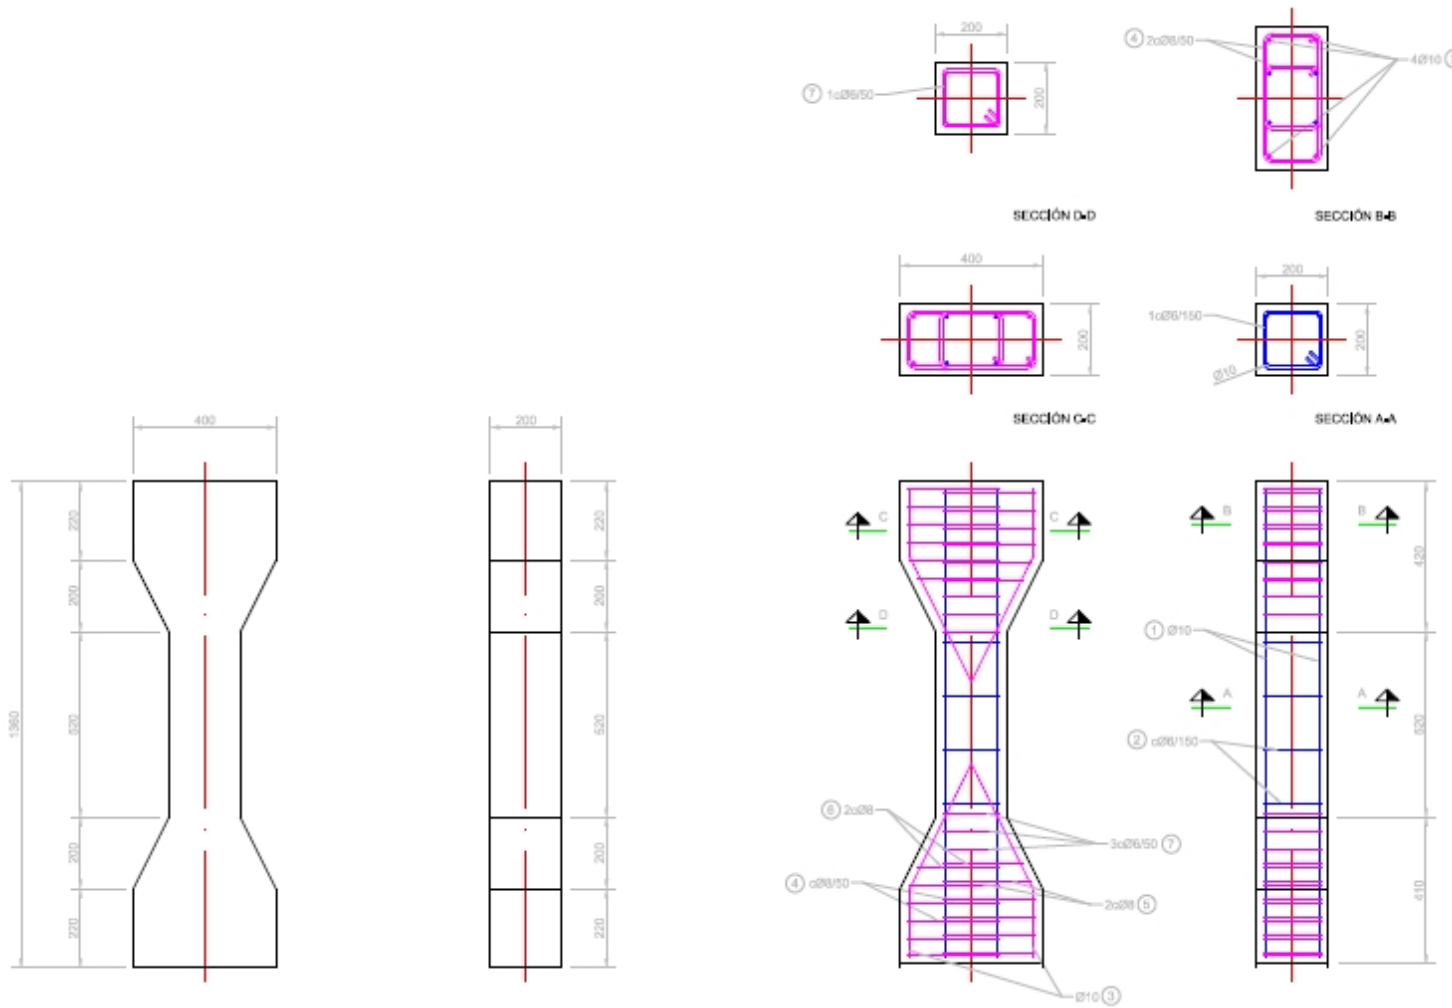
Detalles de la geometría y armado de los pilares de ensayo.
